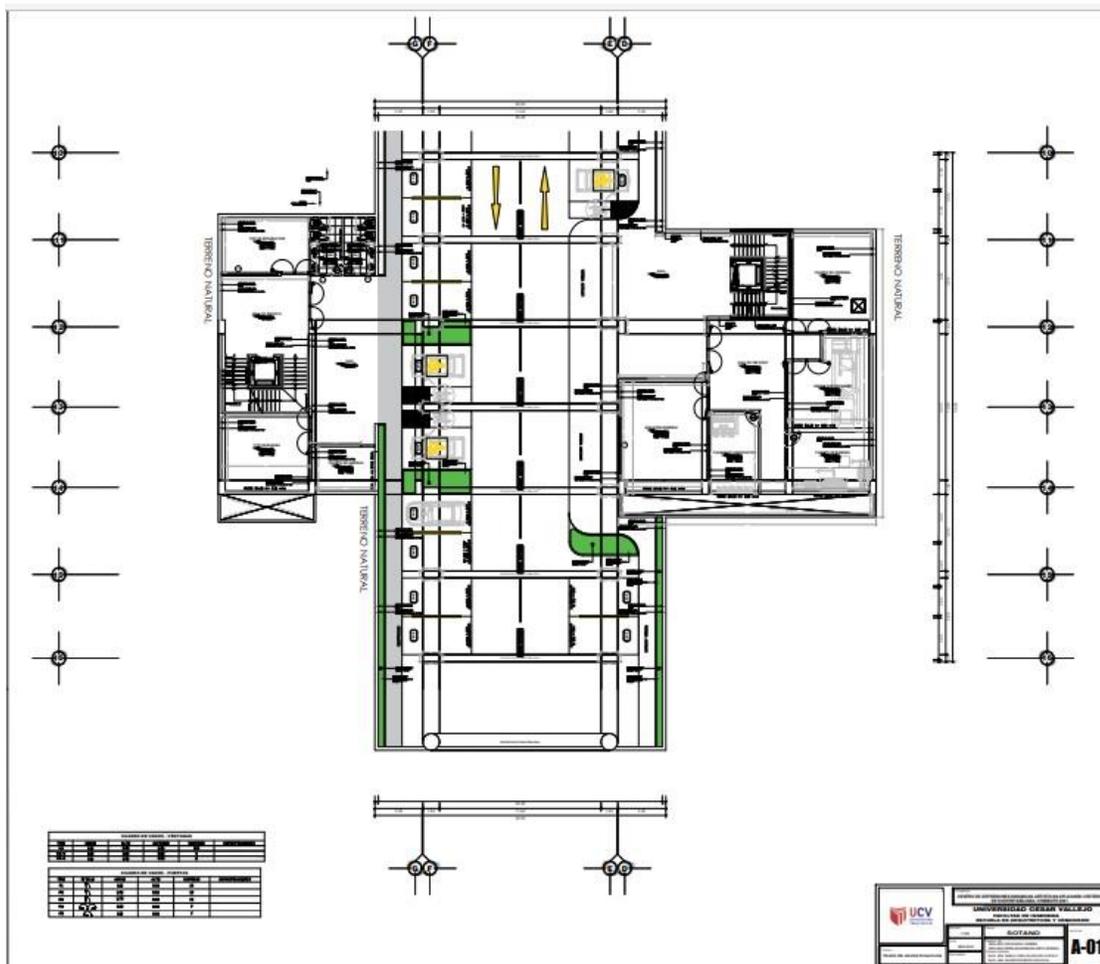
Plano de Detalle Sótano. Fuente: Elaboración Propia
